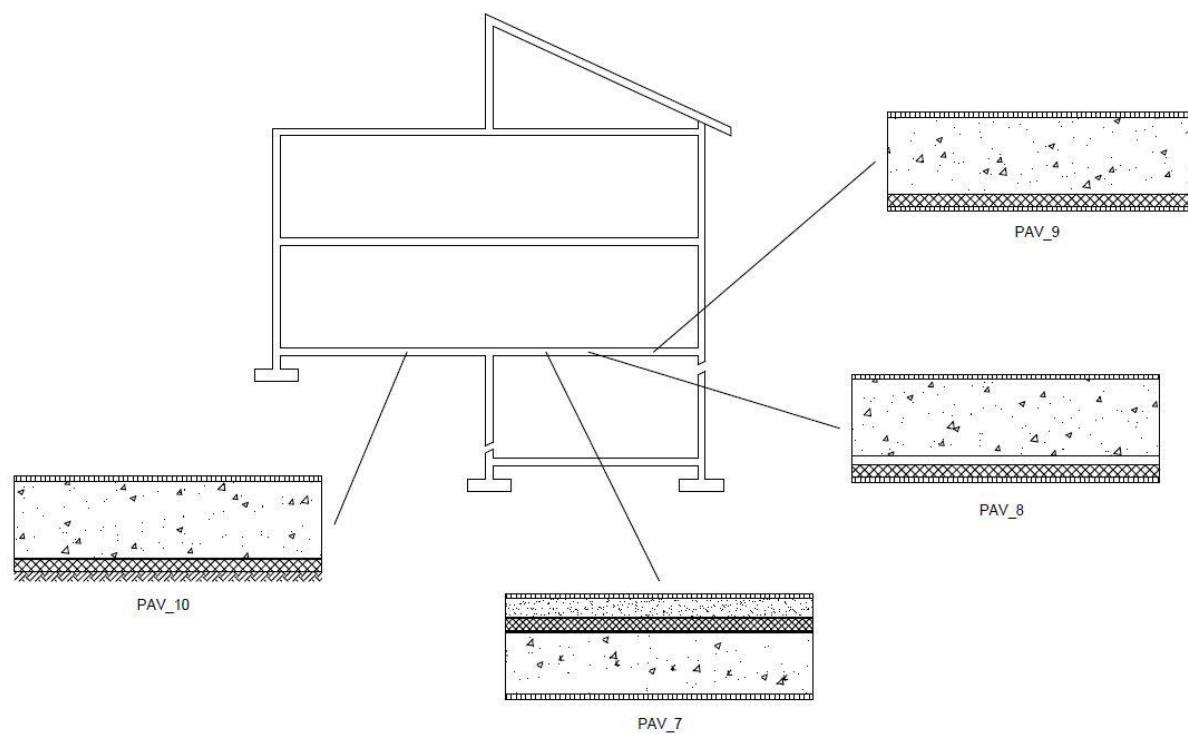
Soluções correntes de pavimentos em edifícios com estrutura porticada de betão armado
